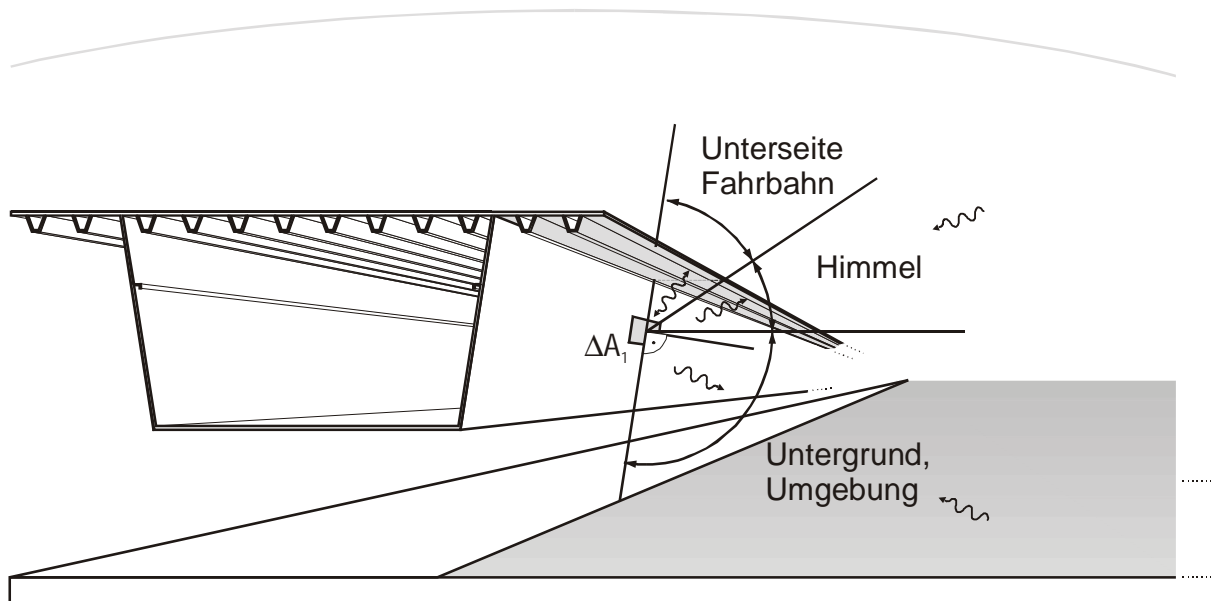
Strahlungsaustausch eines Flächenelementes mit streifenförmigen diffus strahlenden Flächenbereichen: dem Untergrund, der himmelsseitigen Diffusstrahlung und der vom Bauwerk ausgehenden Wärmestrahlung
